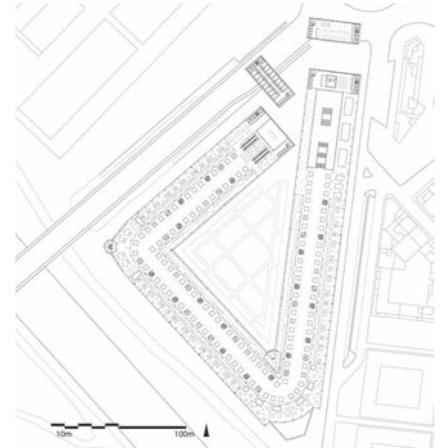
Grundriss Obergeschoss, 2009.
